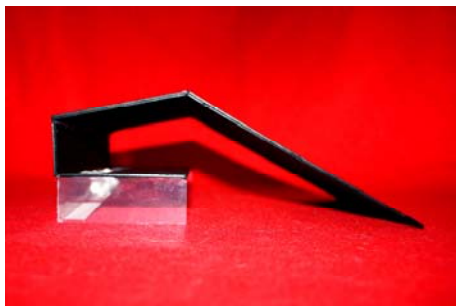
Fotografia da maquete conceptual do pavilhão proposto (permeabilidade).
